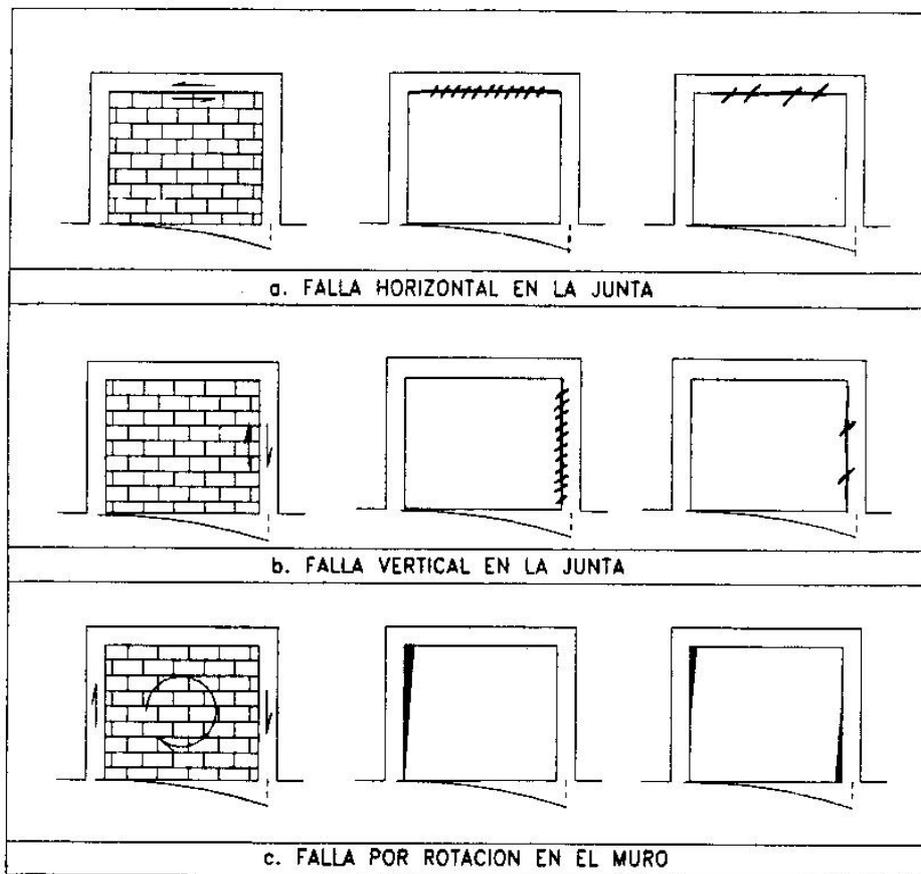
OTROS TIPOS DE FALLAS DEBIDOS AL ASENTAMIENTO EN LAS ESQUINAS DEL MURO O A LEVANTAMIENTO DEL CENTRO DE LA CONSTRUCCION
